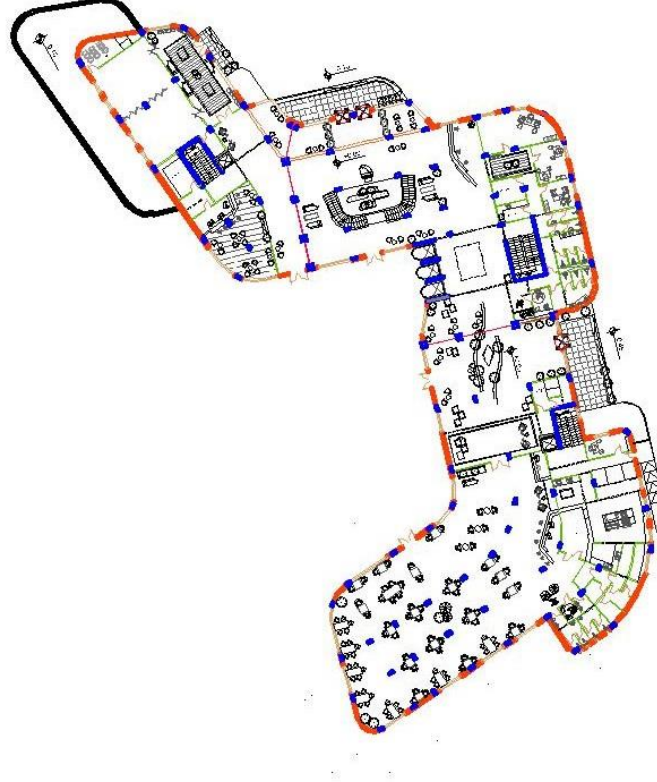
المسقط الأفقي لطابق التسوية الأول.
